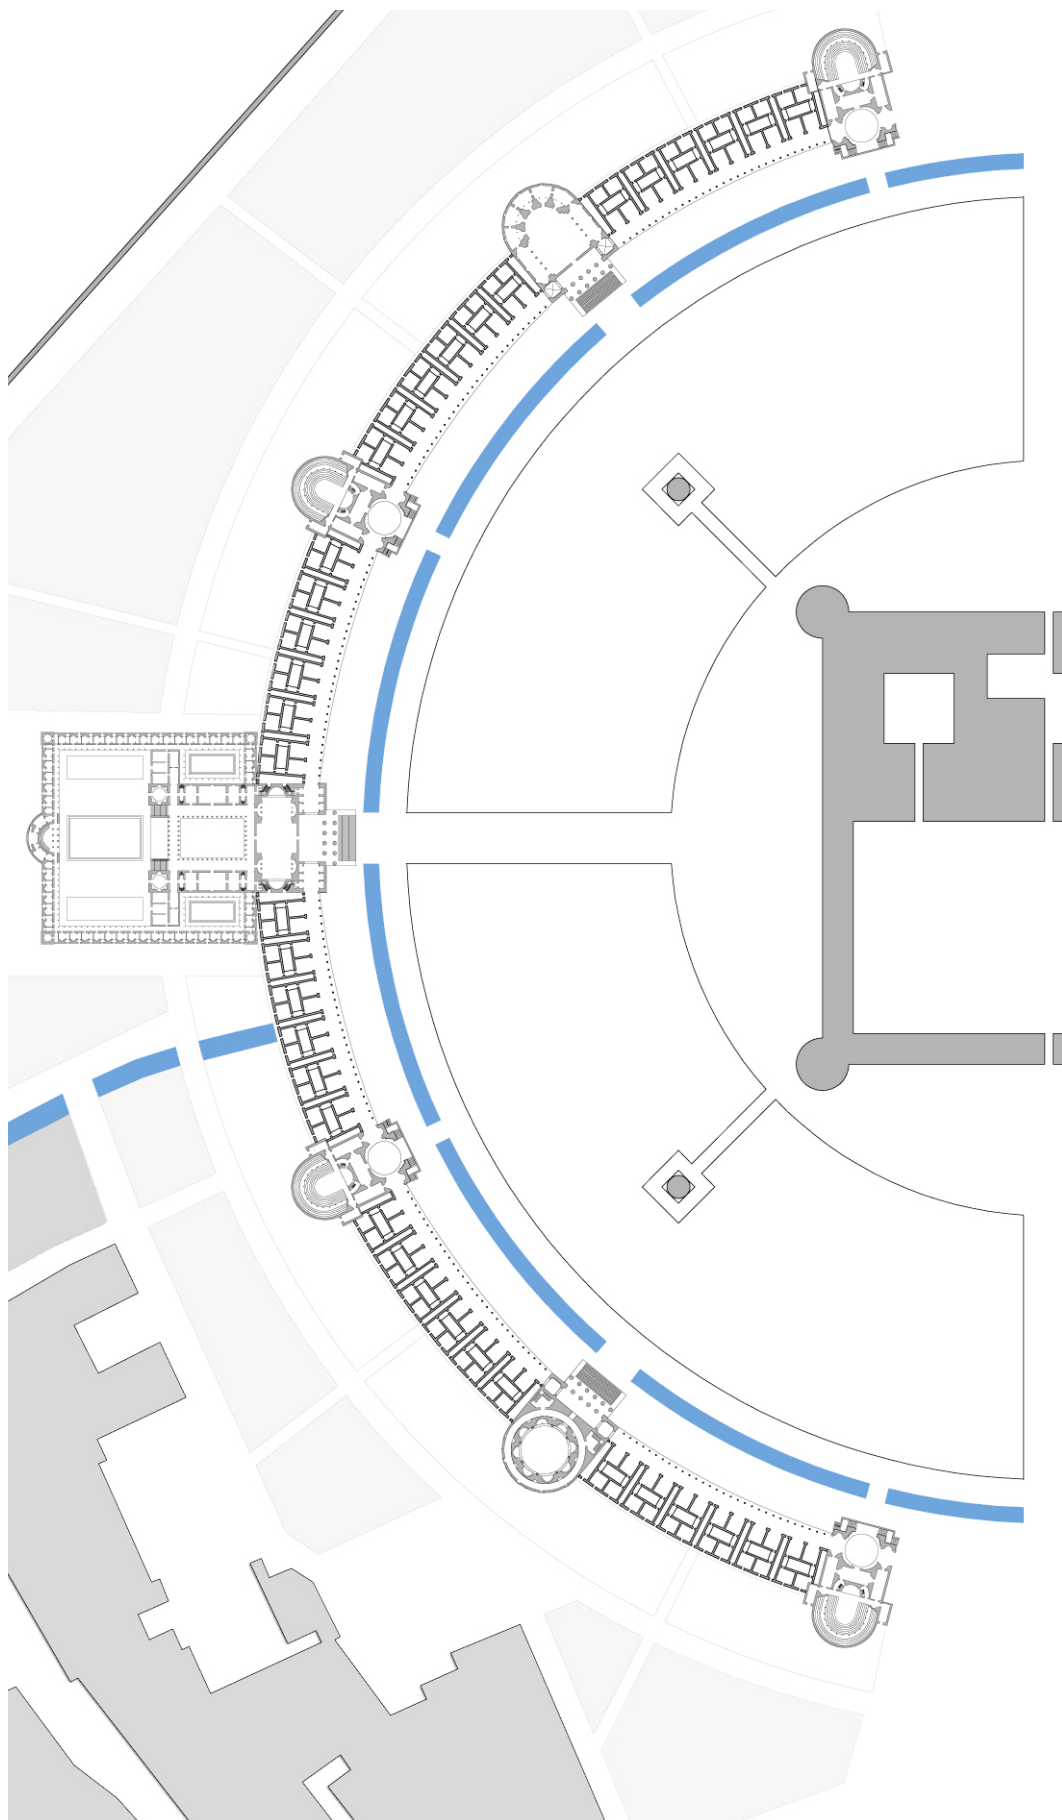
Pianta del piano rialzato del Foro Bonaparte a Milano
